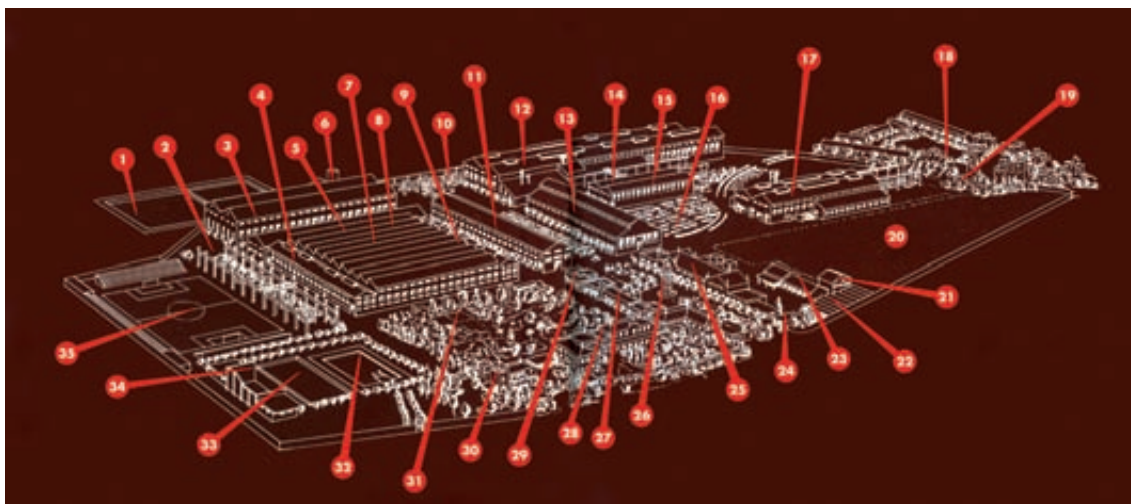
Croquis del conjunto: 1. Balsas refrigeración de motores; 2. Parque piezas fundidas para motores; 3. Taller de monturas; 4. Taller de soldadura; 5. Tratamientos térmicos; 6. Central eléctrica; 7. Taller de motores; 8. Taller de herramientas; 9. Taller de electricidad; 10. Parque de piezas fundidas para auxiliares; 11. Taller de maquinaria auxiliar; 12. Taller de fundición; 13. Almacén general; 14. Parque de fundición; 15. Taller de modelos; 16. Parque de materiales; 17. Taller de forja; 18. Grupo de viviendas de empleados; 19. Residencia de ingenieros; 20. Terrenos ampliación; 21. Parque de material móvil; 22. Aparcadero bicicletas; 23. Garaje; 24. Portería; 25. Comedores; 26. Torre de agua industrial; 27. Laboratorio; 28. Oficinas generales; 29. Clínica; 30. Residencia visitas oficiales; 31. Campo de tenis y jardines; 32. Piscina; 33. Pista de deportes; 34. Frontón y vestuarios; 35. Campo de fútbol. Publicado en INI. *Factoría de Manises de la Empresa Nacional "Elcano"*... 1958.
